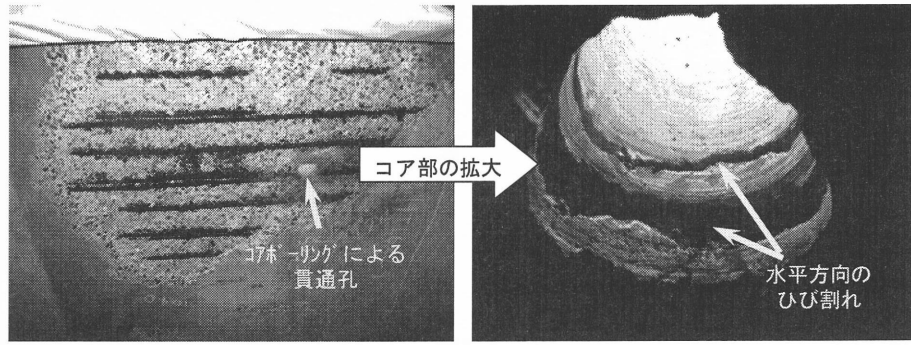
浮き・剥離の2層化状況 (B橋の貫通コア採取箇所)
